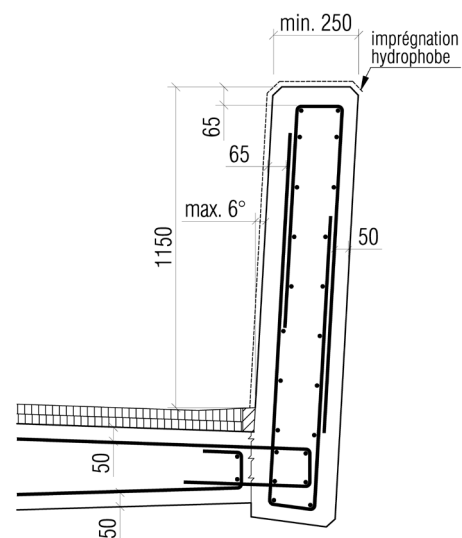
Parapet de sécurité avec profil droit, système 92, GB 1150
